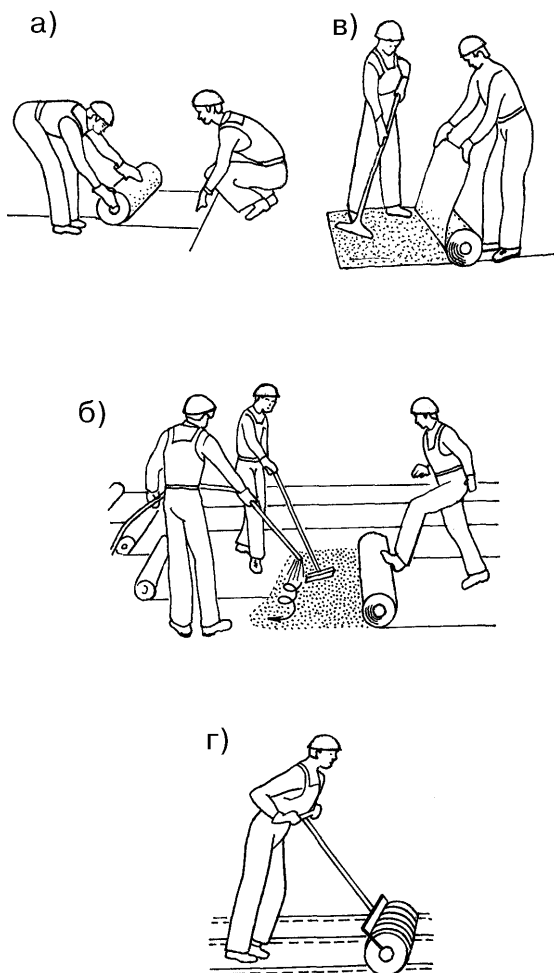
Рулонная кровля. Укладка кровельного ковра
